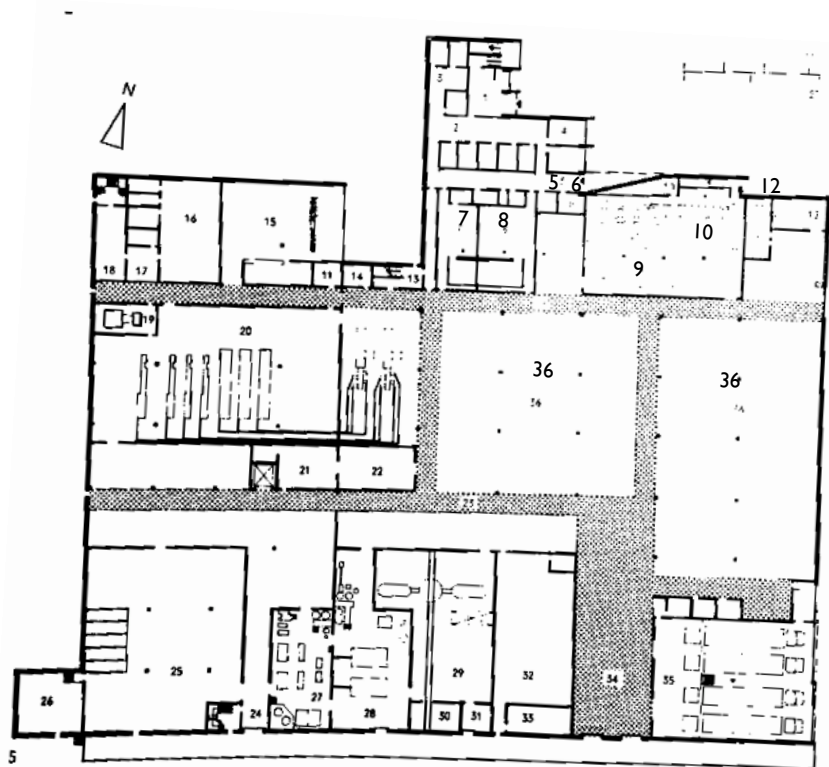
Planta de tratamiento de té. (Grube, O.1972)
